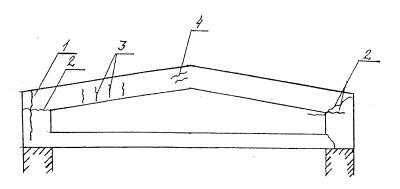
Технологические трещины в железобетонной балке покрытия 1,2 - от расслоения и зависания бетонной массы при бетонировании и расширении металлических паровых рубашек; 3 - усадочные; 4 - от расслоения при бетонировании и от усадки
